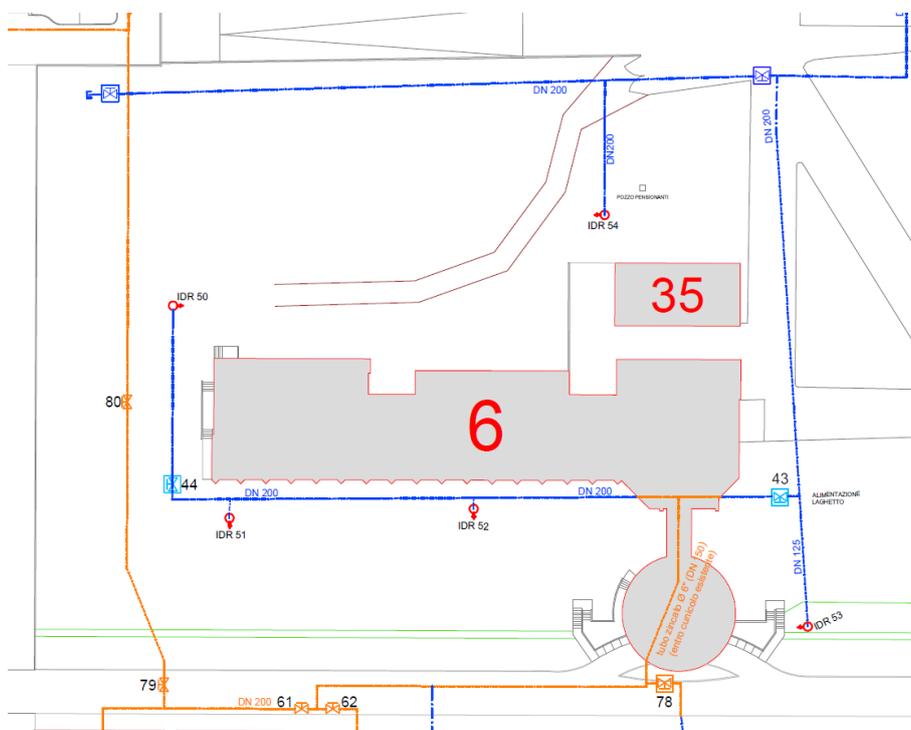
Planimetria del lotto indicata la rete fognaria esistente (in blu)
